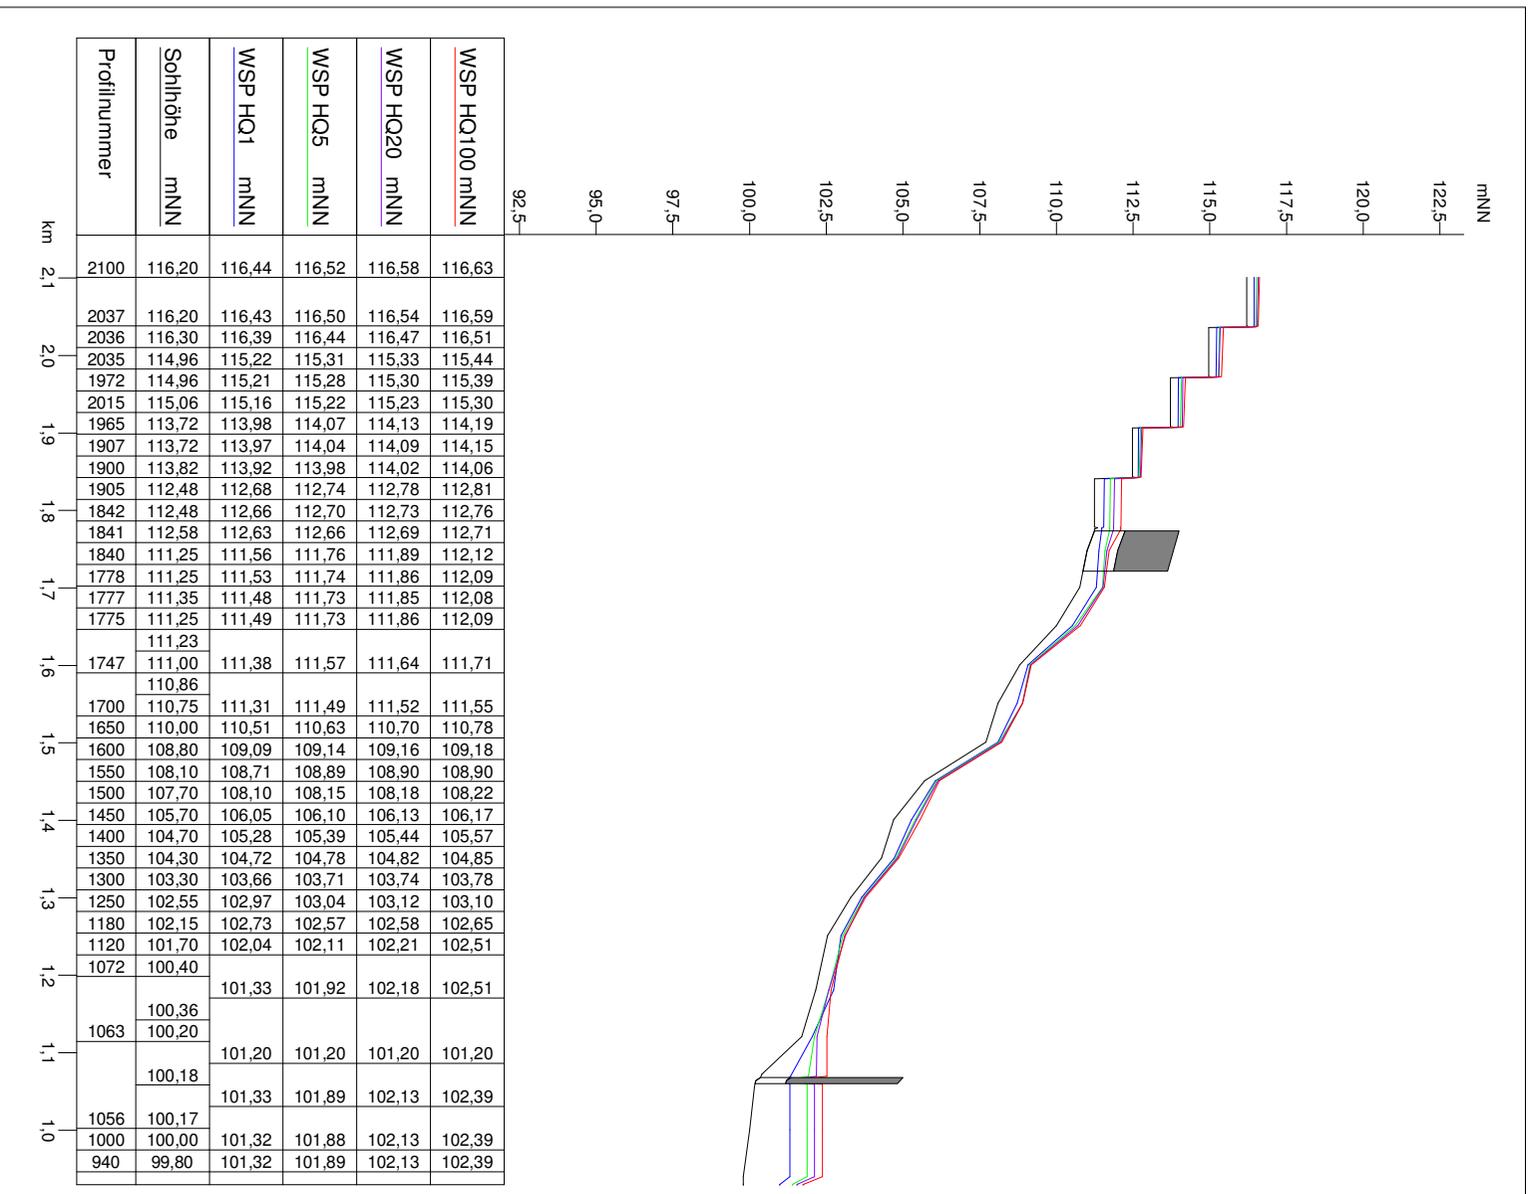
Hydraulischer Längsschnitt (1/2)
